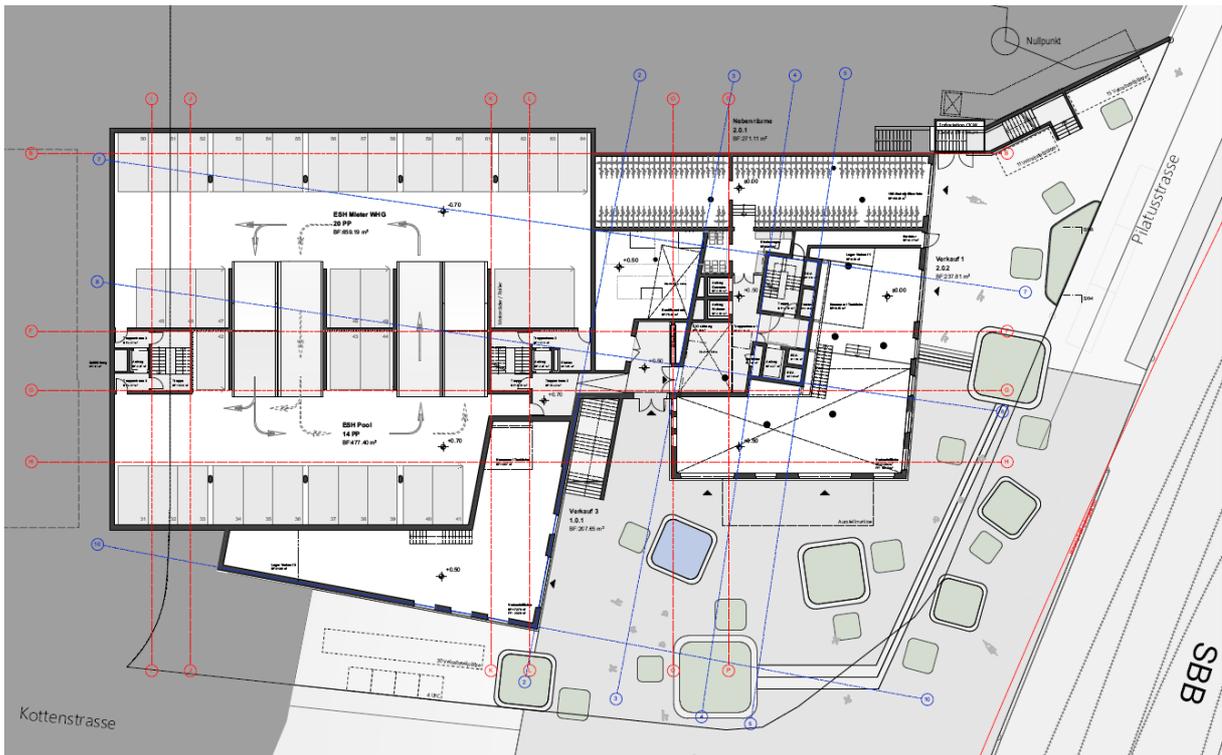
Grundriss Ebene Bahnlinie
